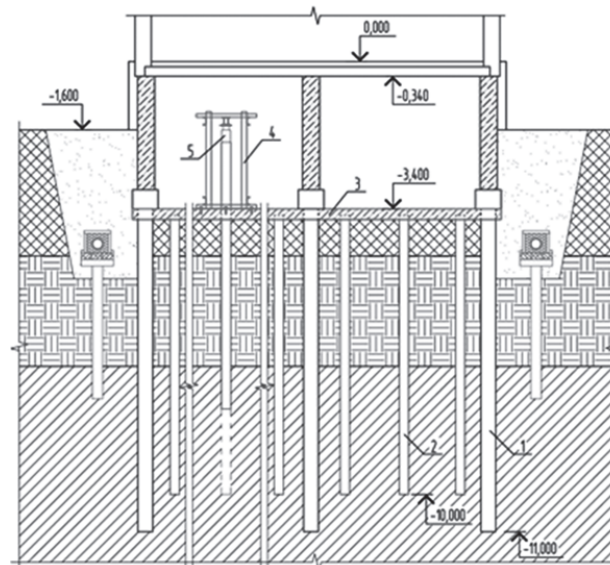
Схема реконструируемого подвала здания с вдавливаемыми сваями:
